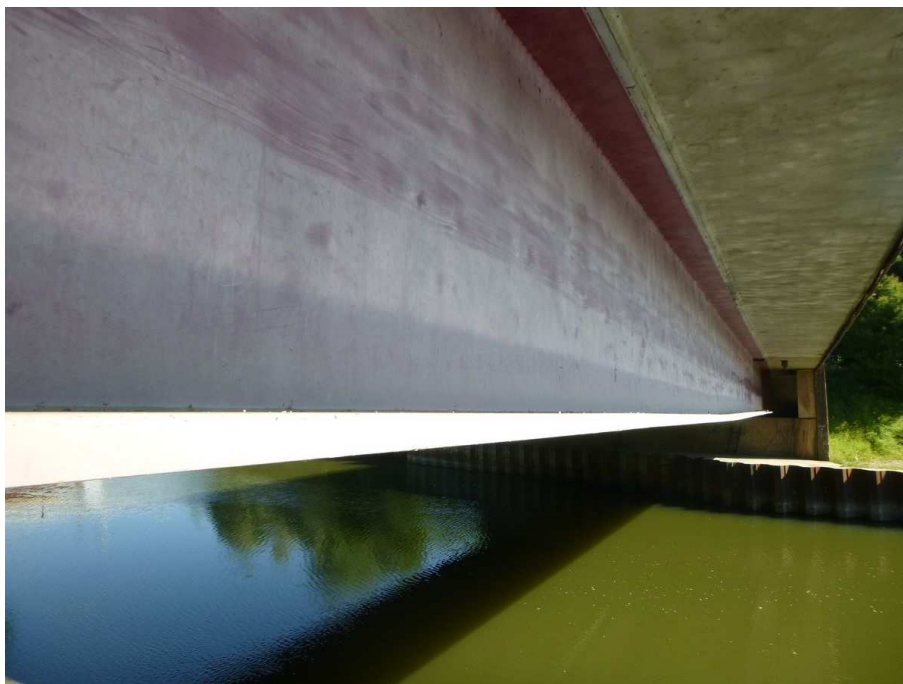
Joint de chaussée non-visible – côté culée C0 (Tablier amont)
